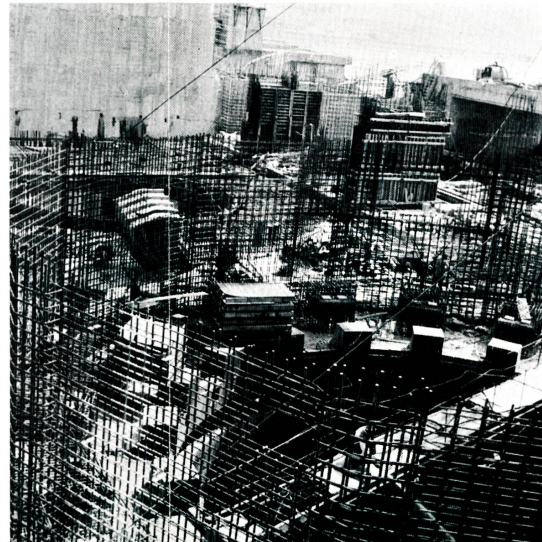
Baugrube für die Maschinen 5 und 6 auf der jugoslawischen Seite des Kraftwerkes «Eisernes Tor».
